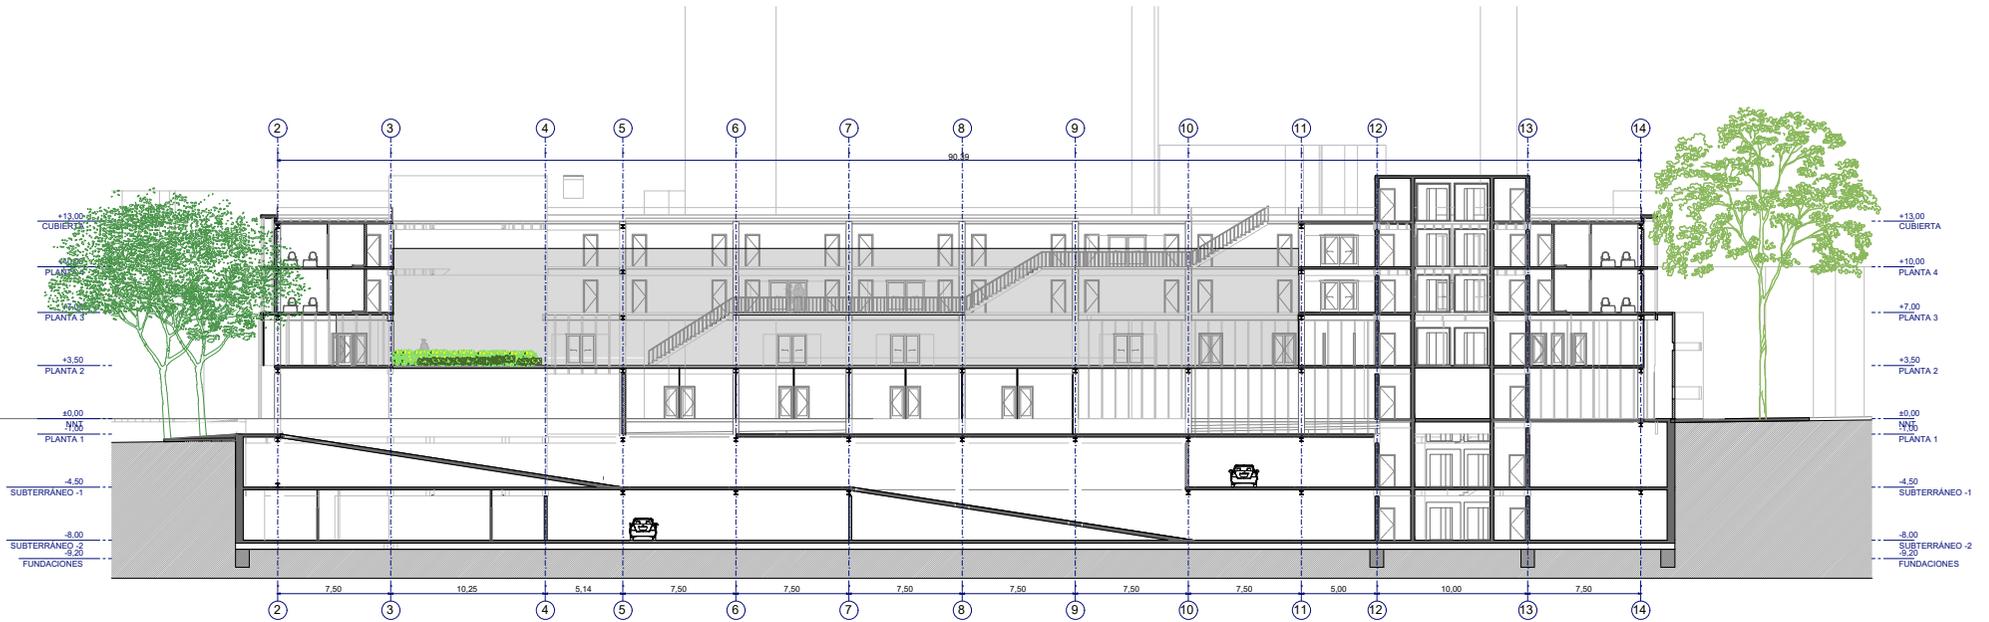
Planimetría cortes. Fuente: Elaboración propia
